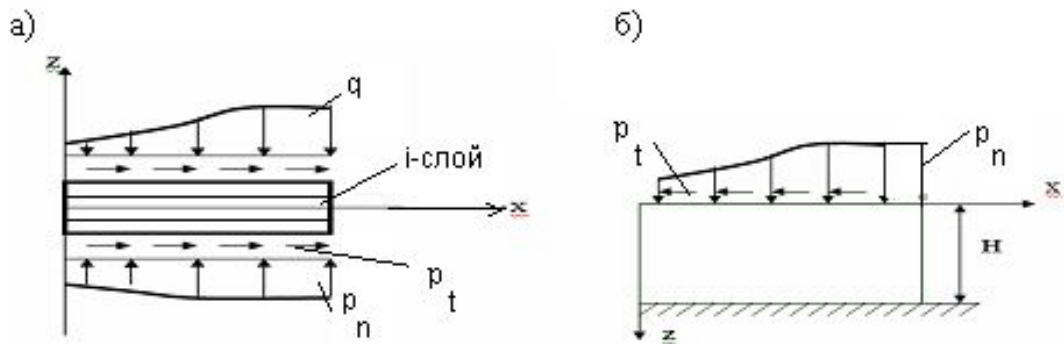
Расчетная схема системы “плита – грунтовое основание”: а) плита; б) Грунтовое основание.
